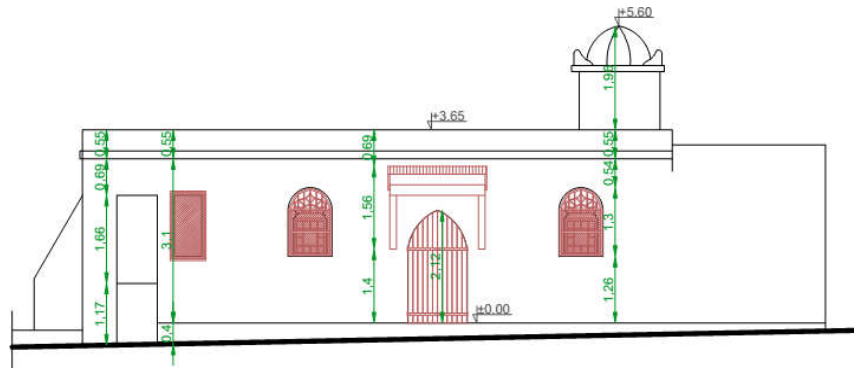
Plan de façade principale de la mosquée Lalla Aziza.
